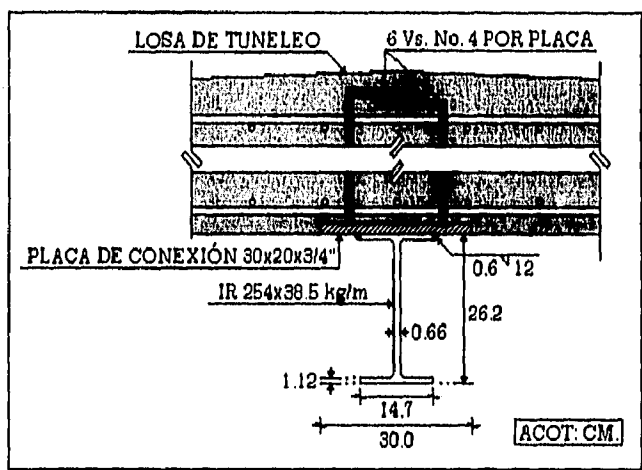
Trabe carril para polipasto, en losa de cubierta.
